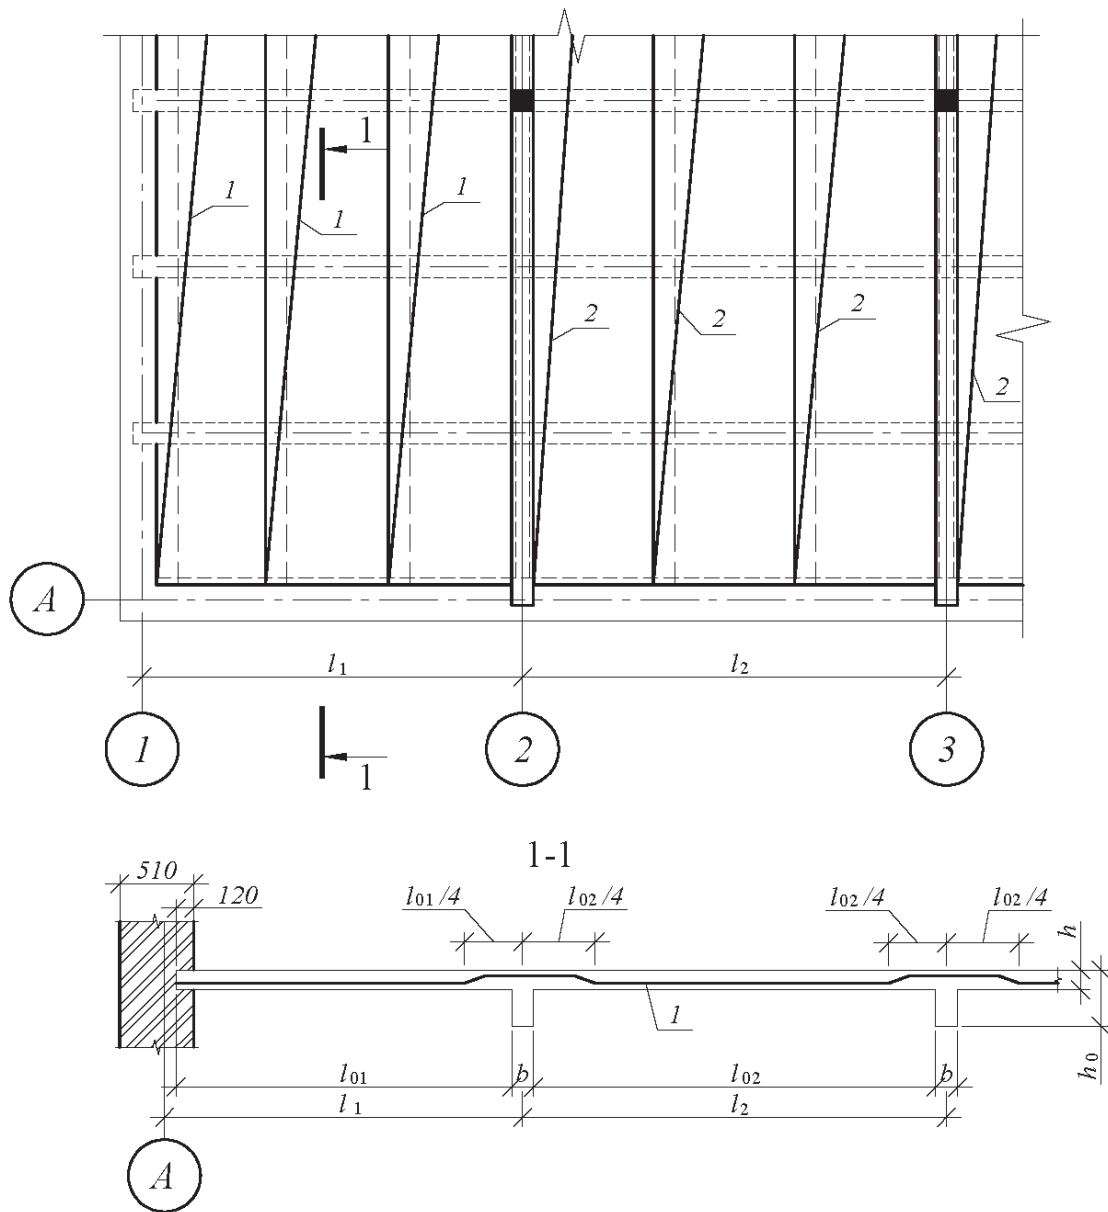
Принципова схема армування плити зварними рулонними сітками
